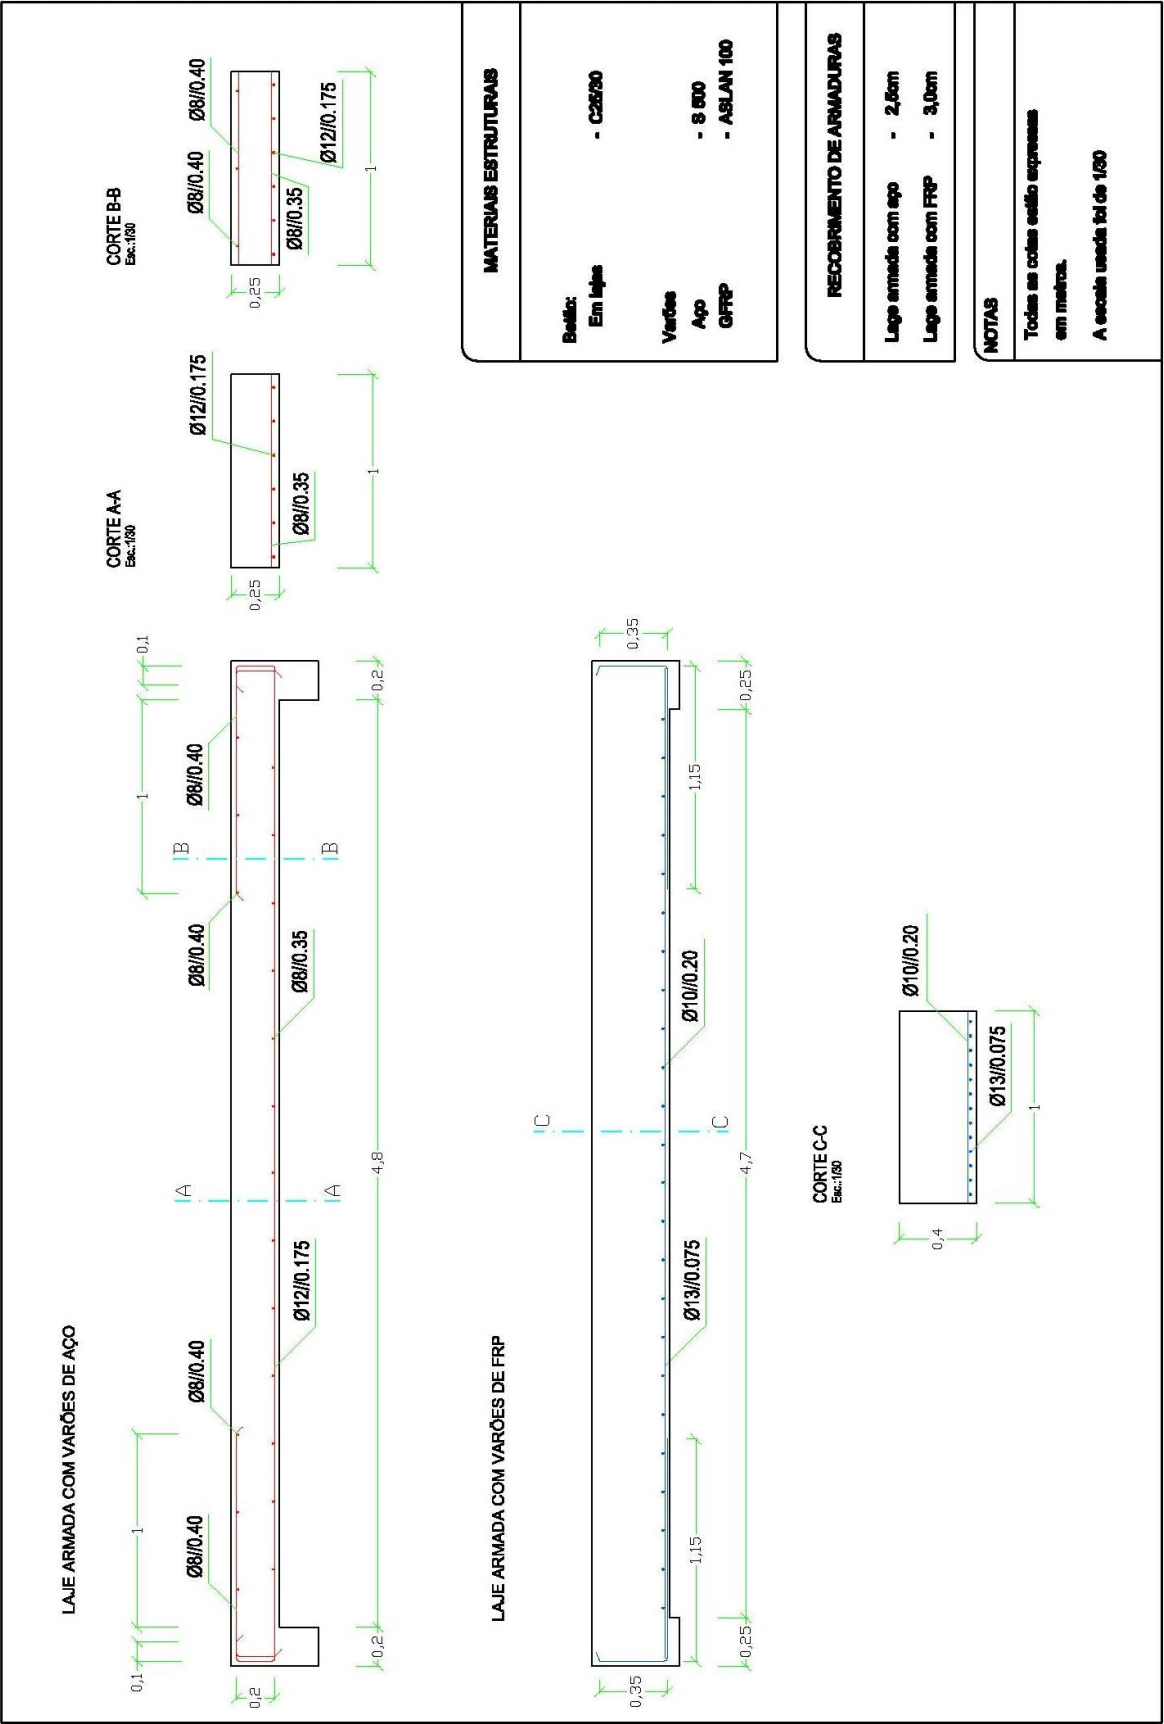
Desenhos das lajes armadas com aço e FRP.
